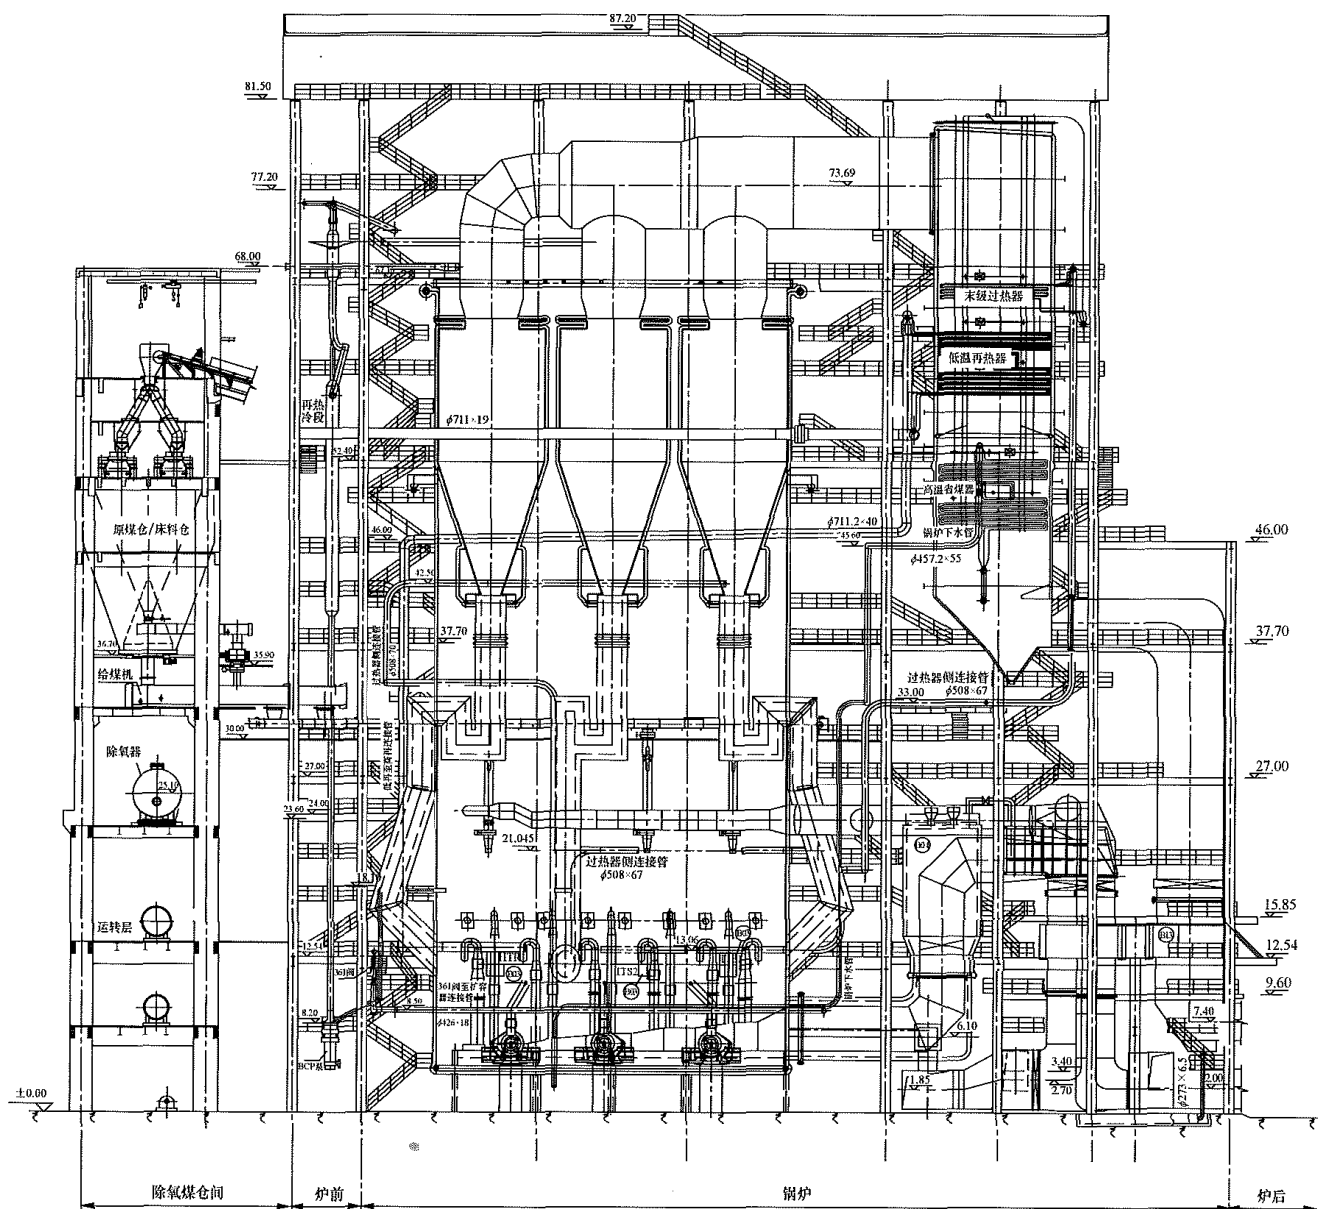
国产 600MW 等级循环流化床锅炉岛主厂房典型布置断面示意图
